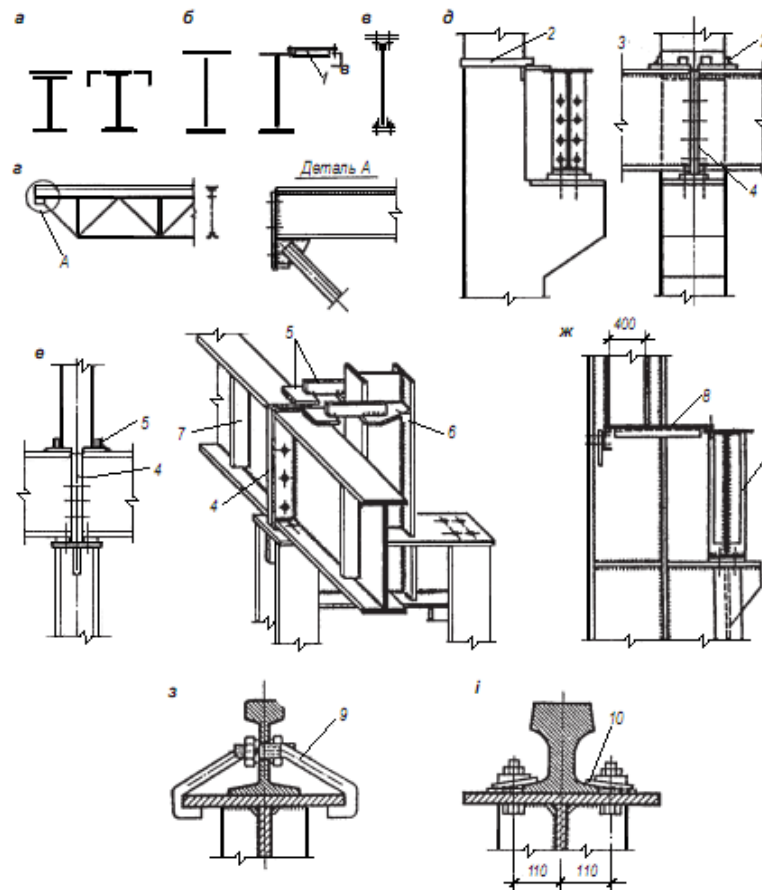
Сталеві підкранові балки: а - в – суцільного перерізу; г – наскрізного перерізу; д – кріплення балки до залізобетонної колони; е, ж – те ж до сталевій колони; з – кріплення рейки до балки крюками; і – те ж лапками; 1 – гальмова балка; 2 – хомут зі смуги 8 × 100 мм; 3 – упори з кутиків; 4 – кінцеве опорне ребро; 5 – кріпильні планки; 6 – фасонка; 7 – ребра жорсткості через 1,5 м; 8 – гальмова балка зі сталі; 9 – крюк; 10 – лапки через 0,6 - 0,75 м
